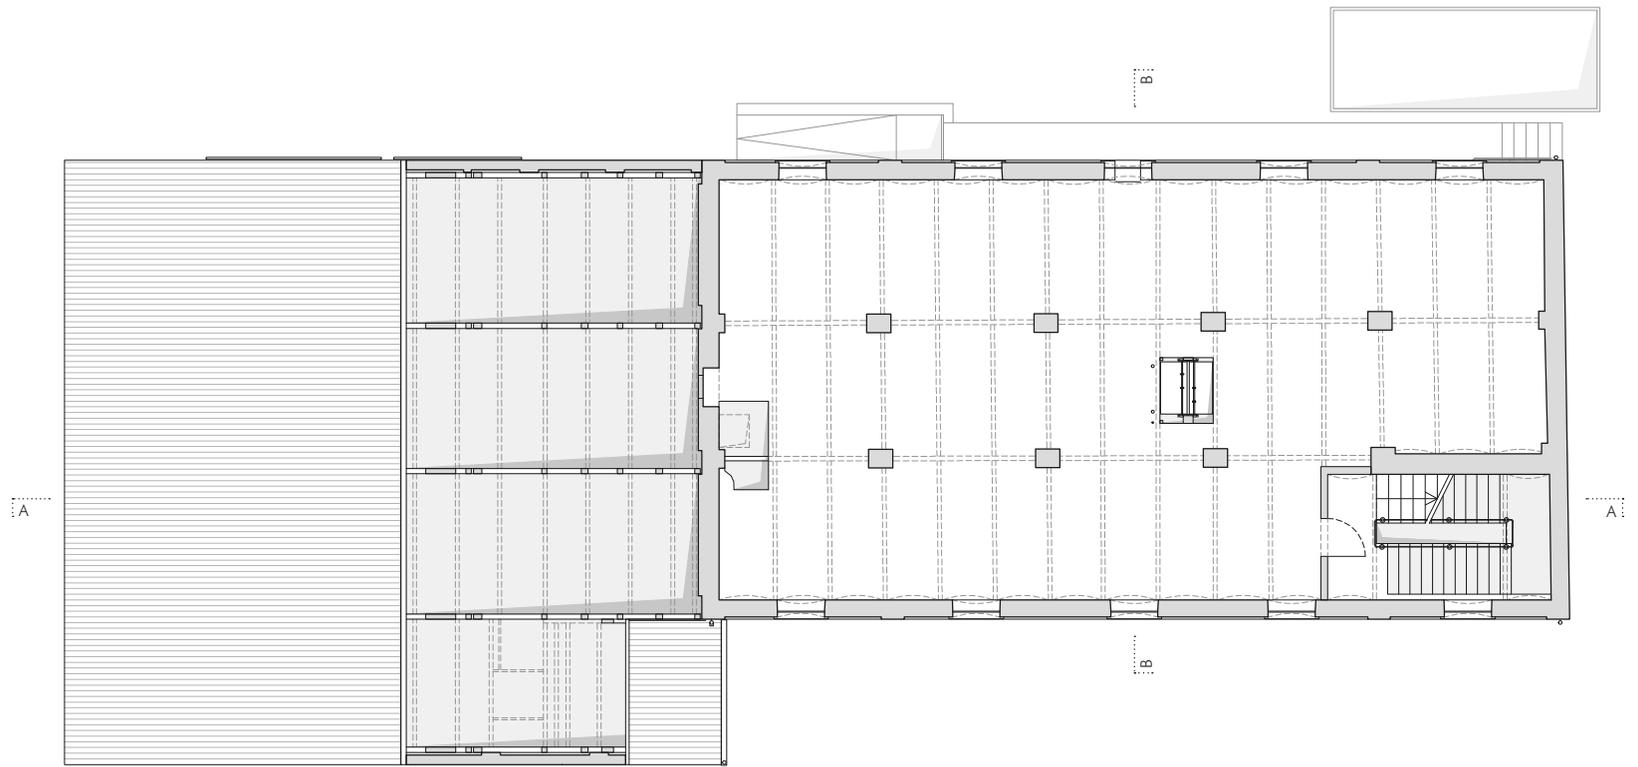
Grundriss 1. Obergeschoß, Bestand, M 1:200
